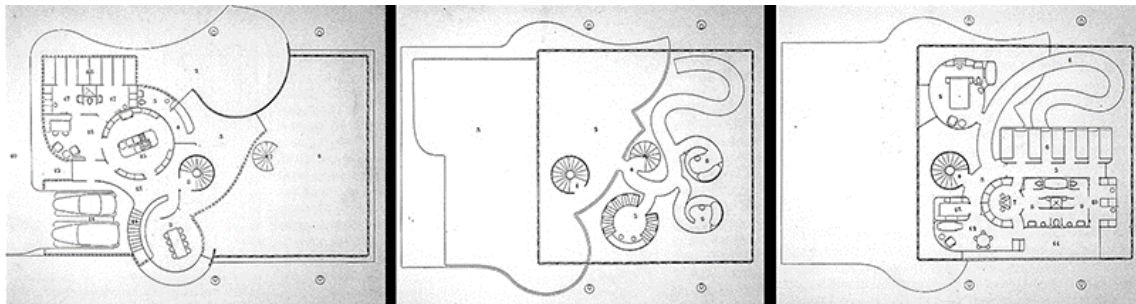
Paul Nelson, Planta baja, primera y segunda de su Maison suspendu, 1938
